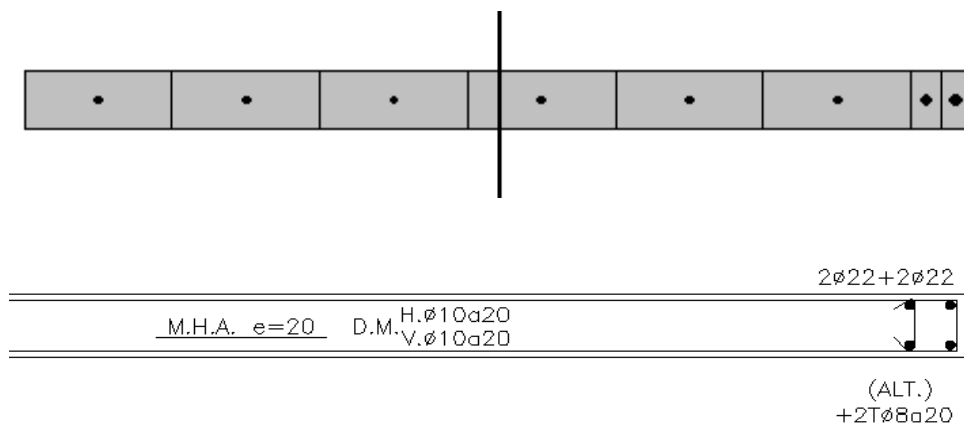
Sección transversal de un elemento tipo muro dividido en fibras en Perform 3D.
